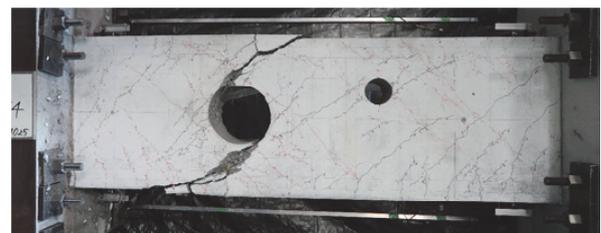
試験体破壊状況 (No.19 : H/D=1/2.5)
